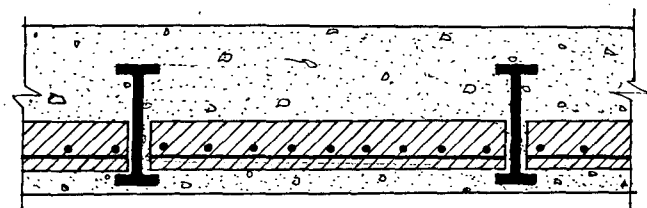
SISTEMA PRÉ-MOLDADO MONIER (SEGURADO, 1967)
